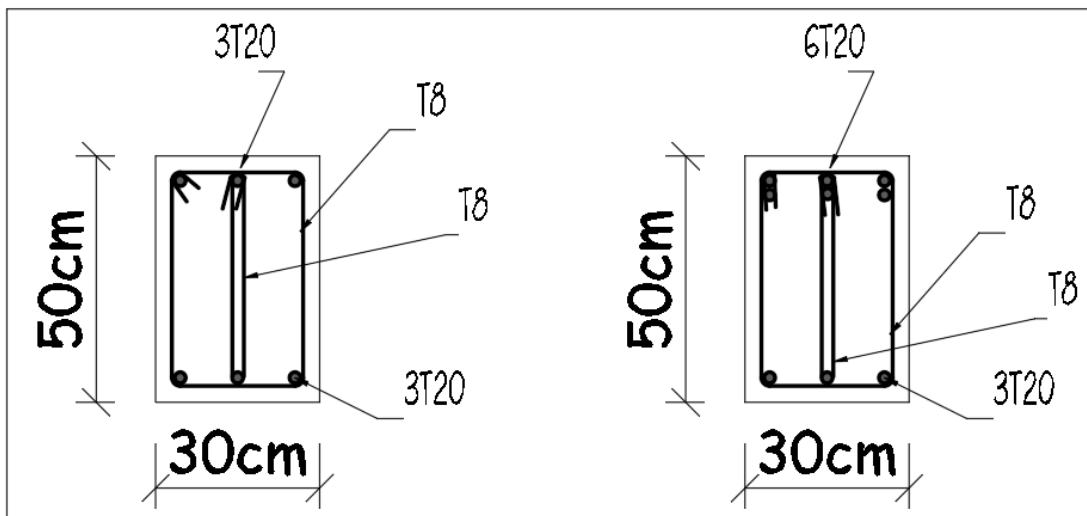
Ferraillage de la poutre secondaire du 6ème au 9ème étage
